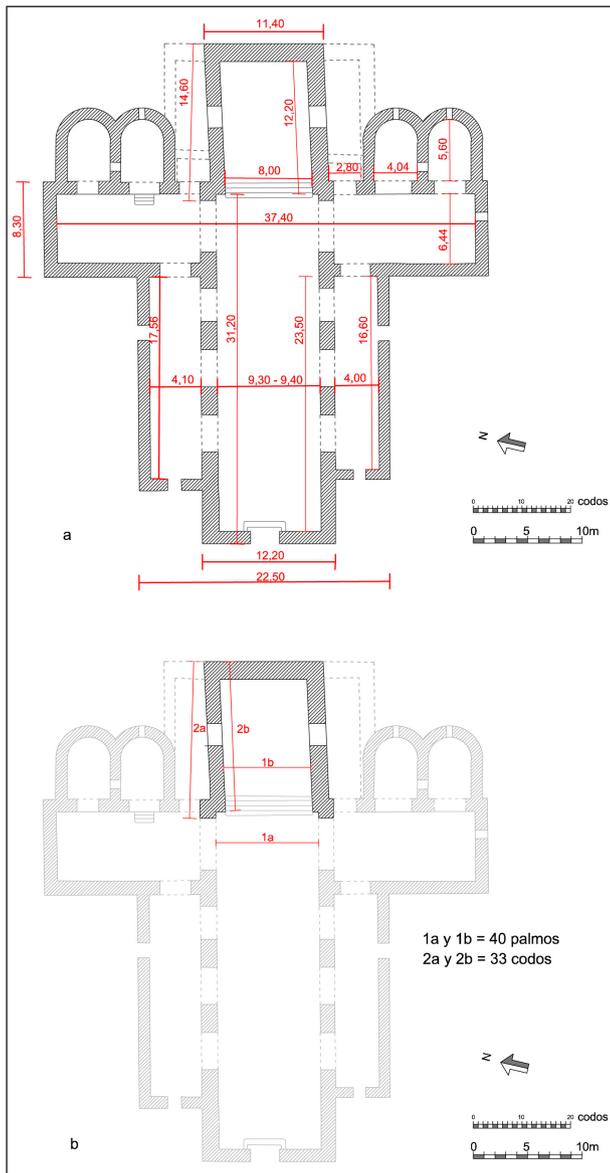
6a. Planta de la fase del siglo X con cotas actuales (planimetría de la autora). 6b. Posibles medidas del monje Garsias (planimetría de la autora).
